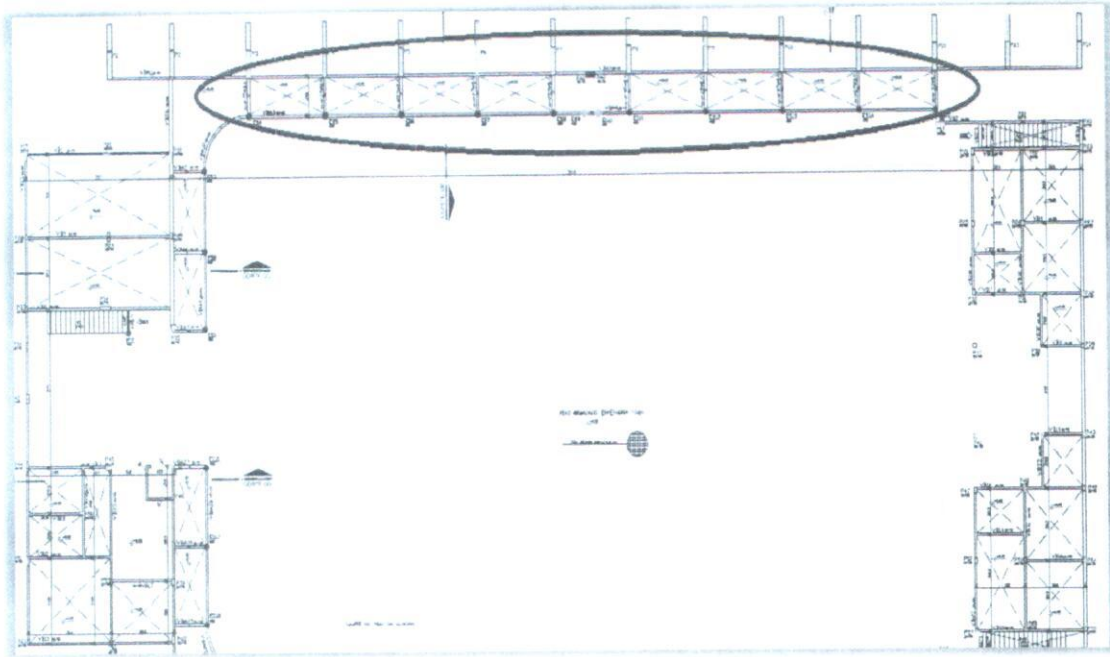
PLANTA DE FORMA DO CINTAMENTO
